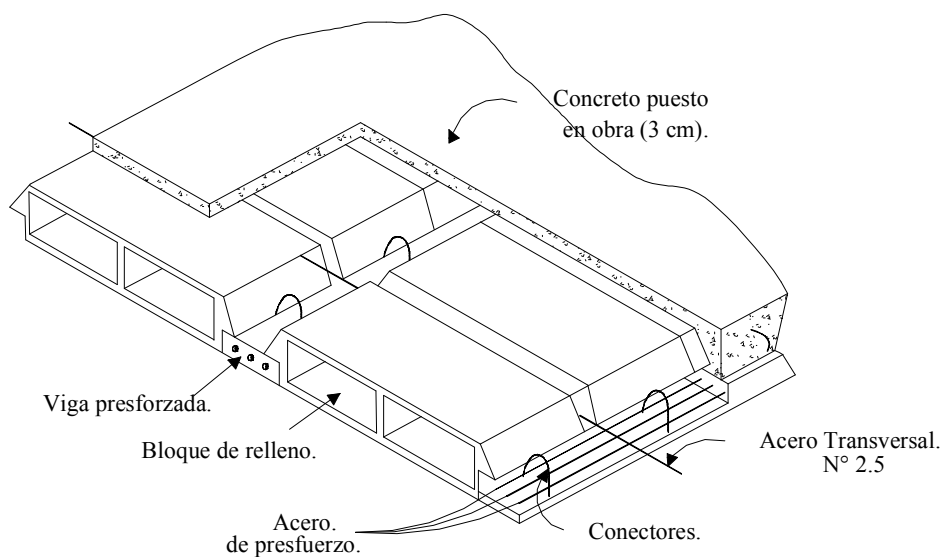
SISTEMA DE BOVEDILLAS SOBRE VIGUETAS
